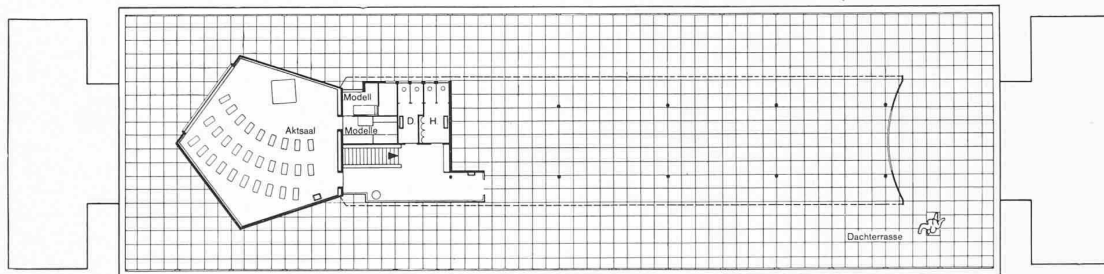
Grundriss der Dachterrasse, links der Aktsaal (vgl. Abb. 10). Masstab 1 : 500
